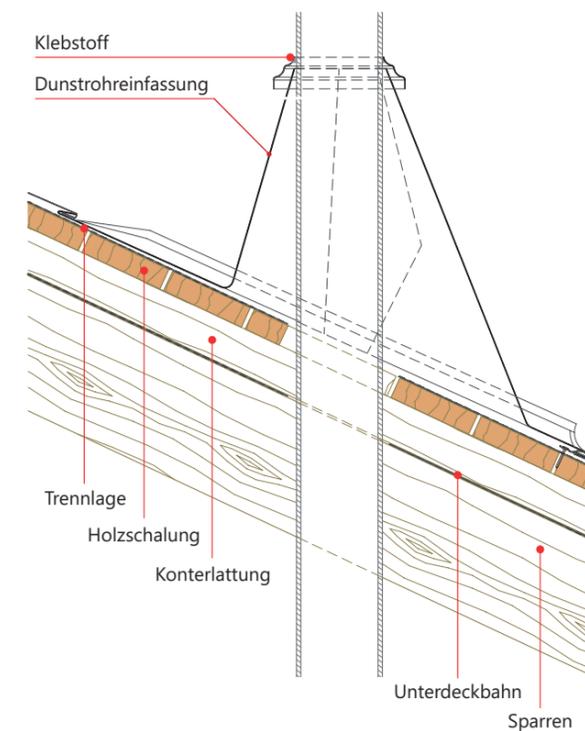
DETAIL DACHÜBERGANG IN STEHFALZEINDECKUNG
